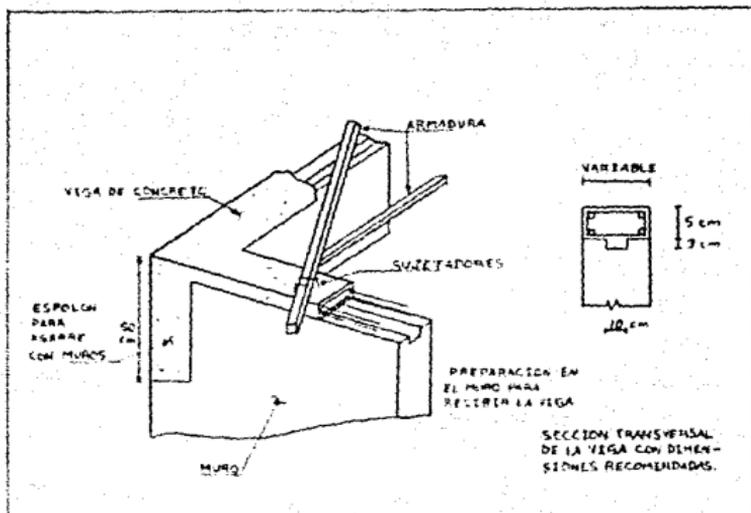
Detalle de anclaje cubierta-cadena de concreto.
